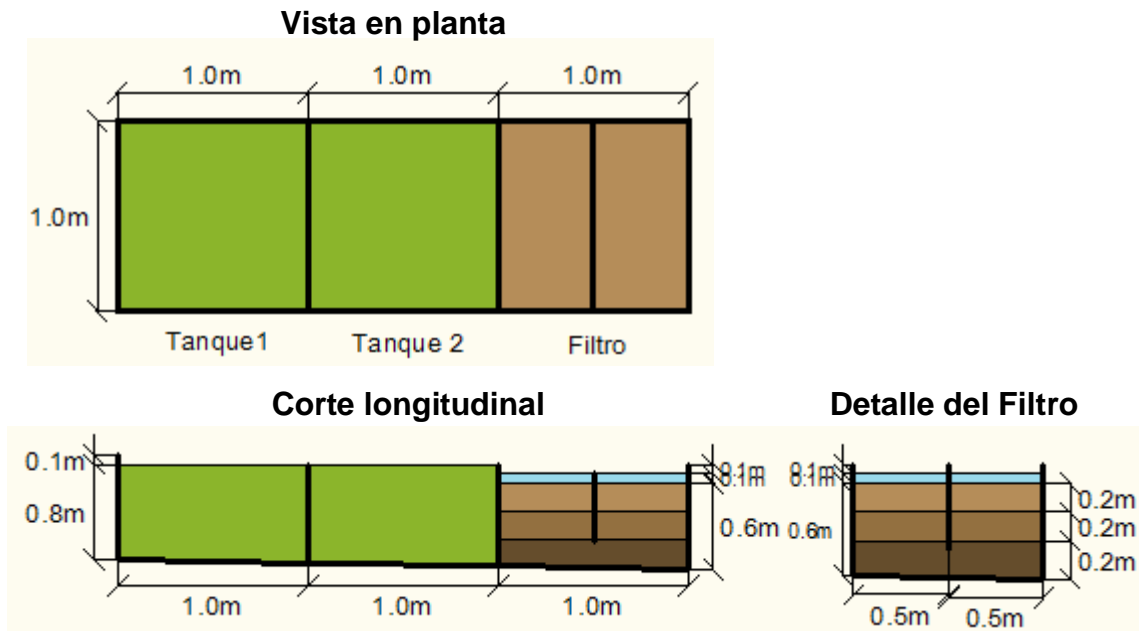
Vista en planta, corte longitudinal y corte transversal de la Albercas Biológica.
